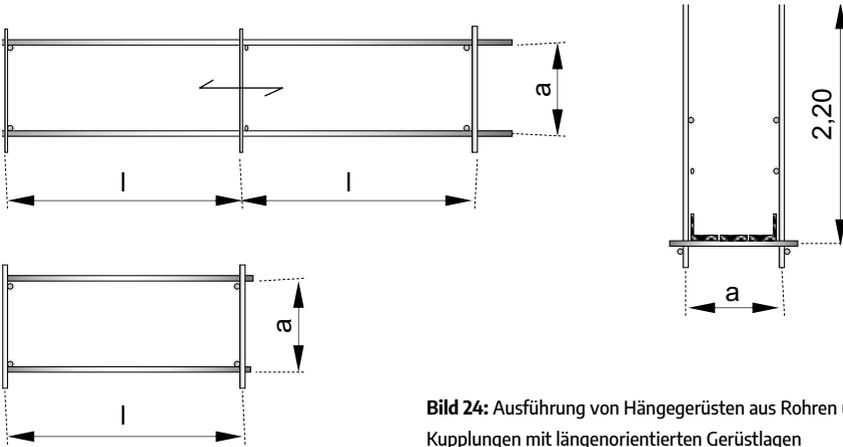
Ausführung von Hängegerüsten aus Rohren und Kupplungen mit längenorientierten Gerüstlagen
